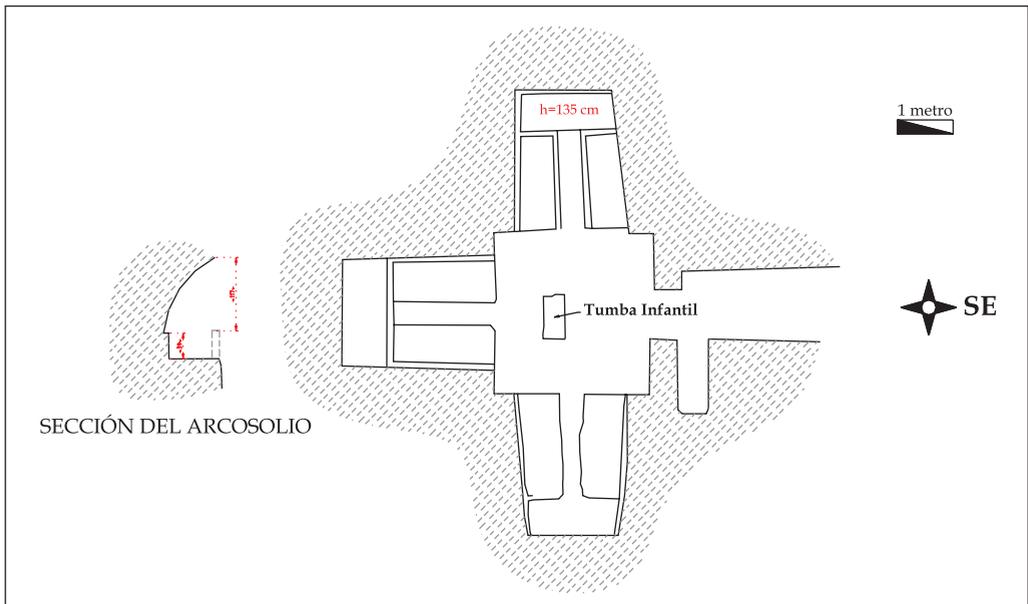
Planta del hipogeo QM C3/38. Tipo 3
